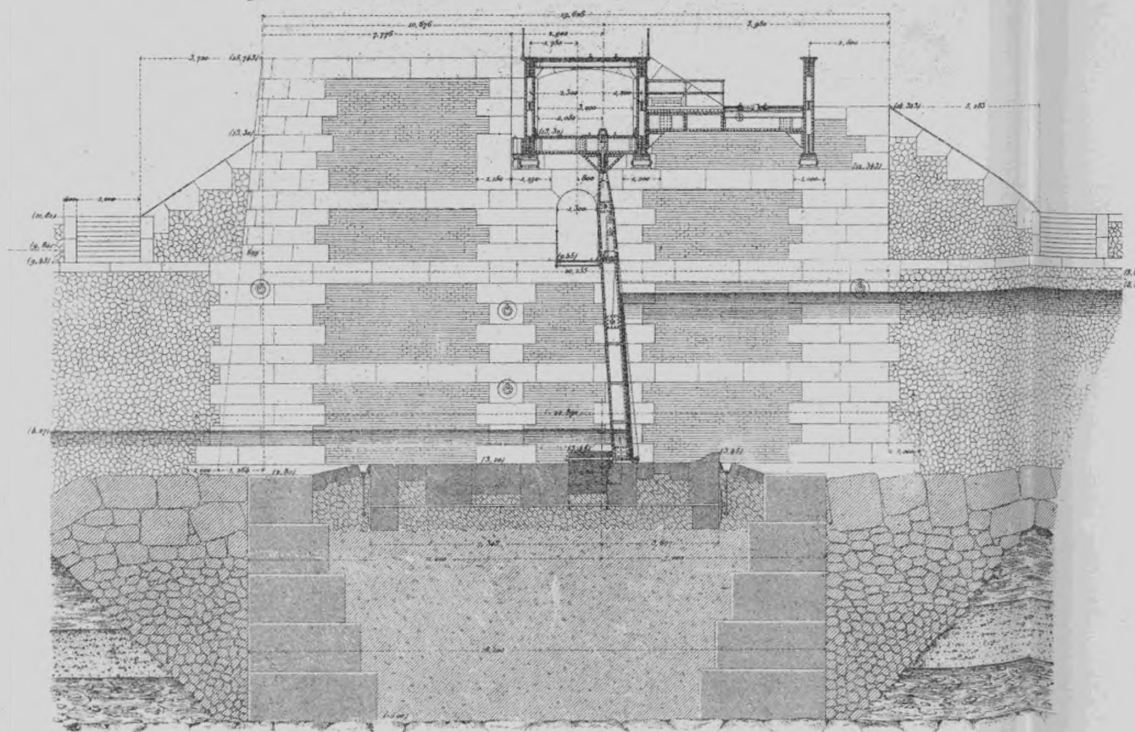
Coupe d'une passe profonde non navigable s: KL et Elevation de la culée rive droite.
